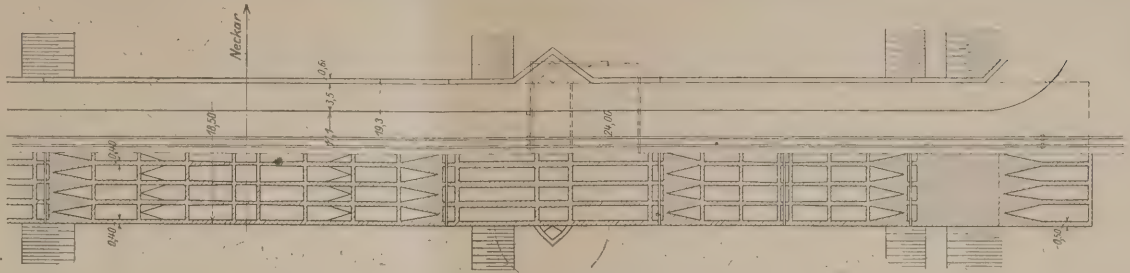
Grundriß oben mit Fahrbahn, unten ohne Fahrbahn.
